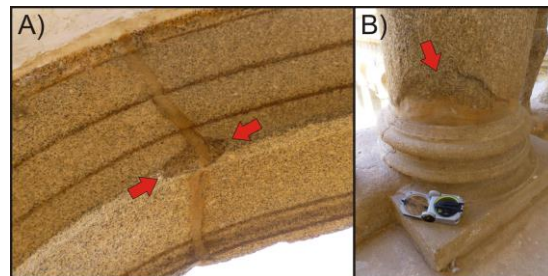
Esquinas fracturadas (*dipping broken corners*) en dovelas y base de columna del claustro SW en el segundo piso.
